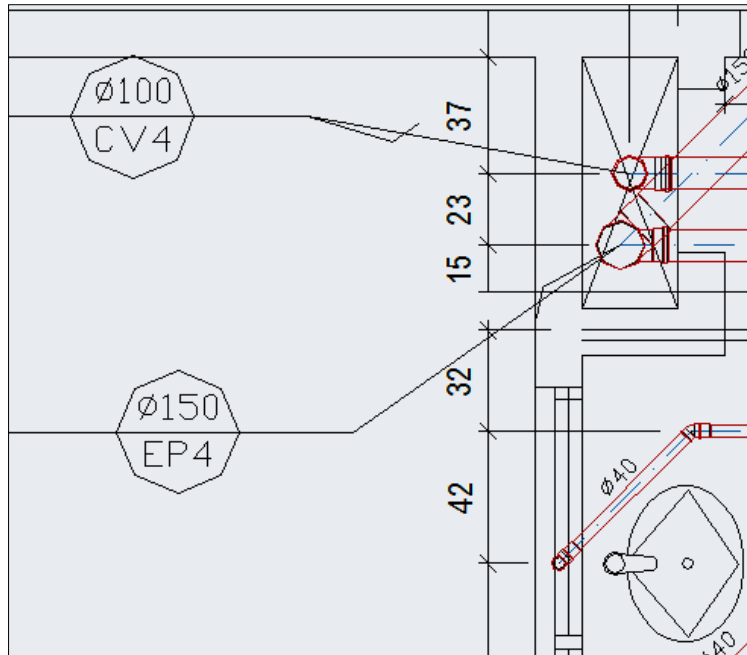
Desenho Técnico detalhe do sifão; Fonte: Rodovalho, R. Ana Cristina
